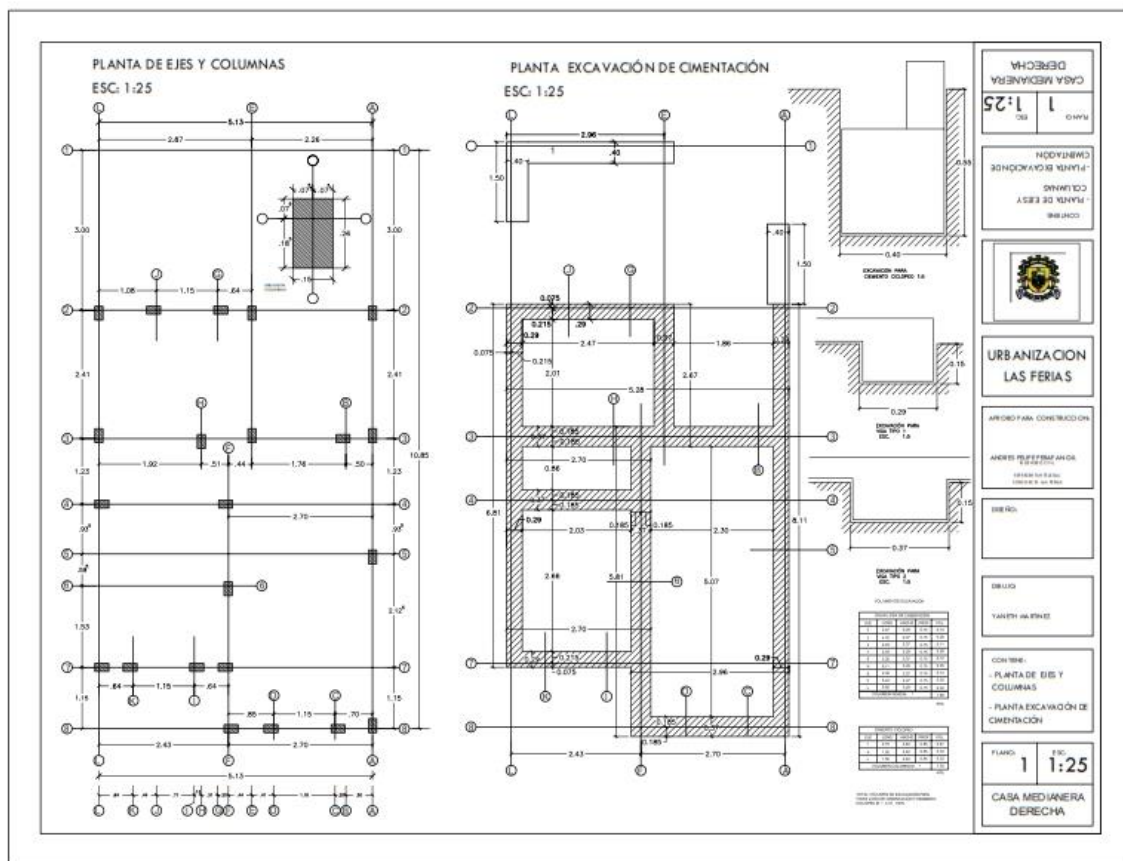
Planta de ejes, columnas, excavación de cimentación.
